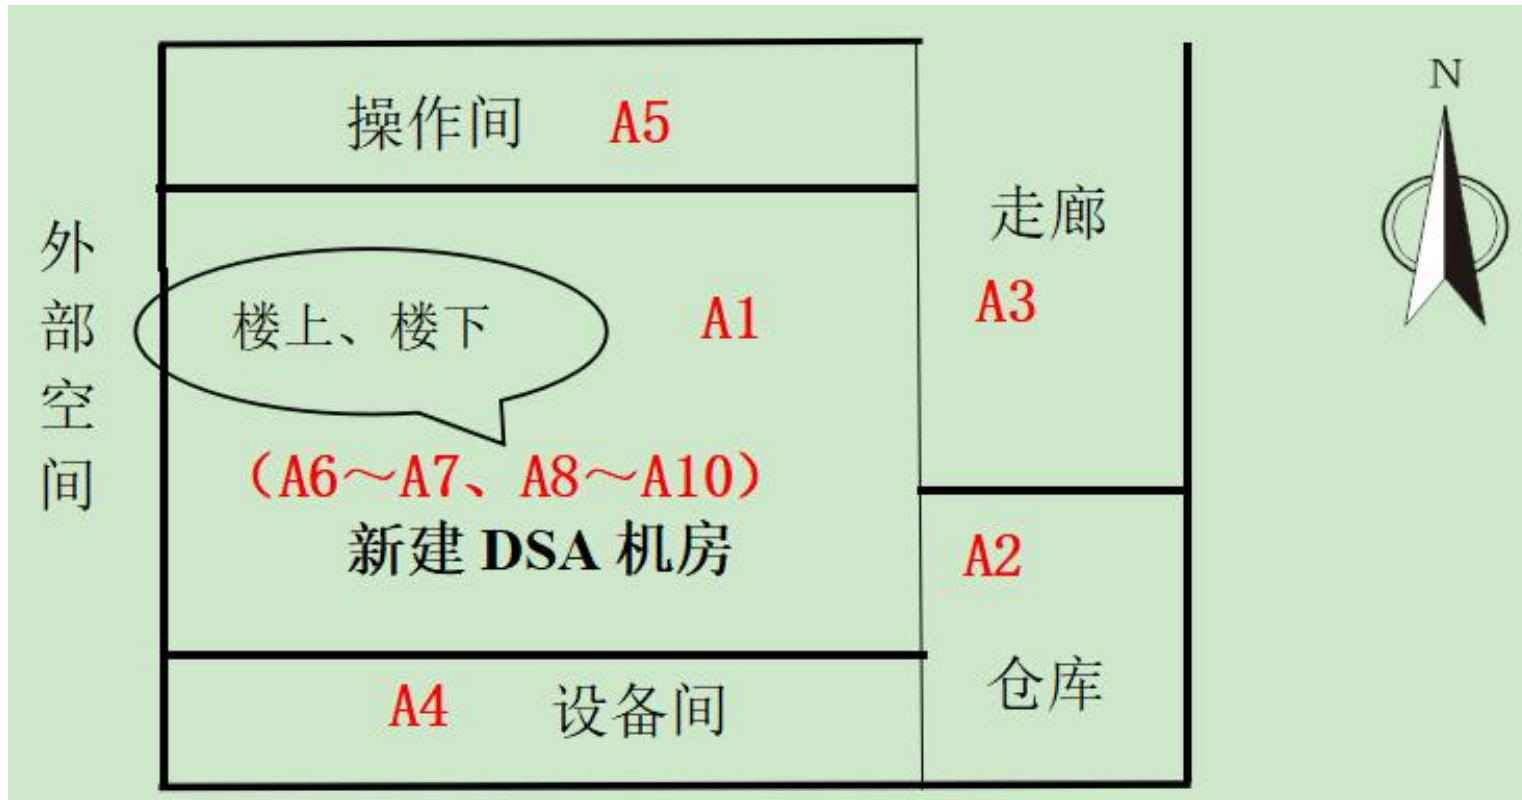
青岛市胶州中心医院 DSA 机房总平面布置图
